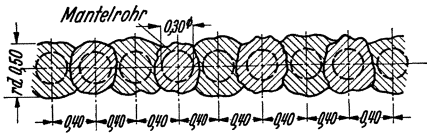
Herdmauer aus bewehrten Preßbetonpfählen. Querschnitt.
